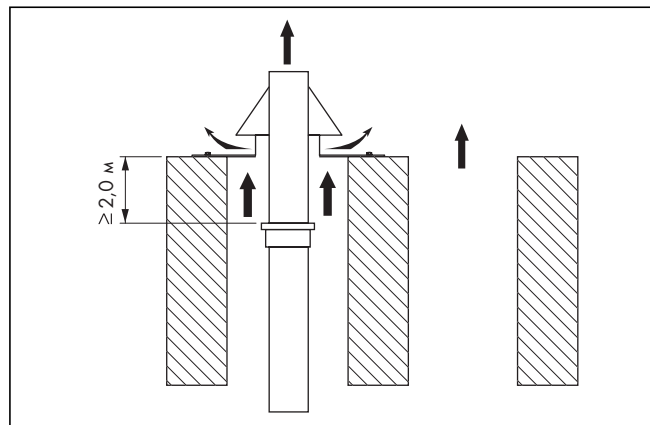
Высота дымовой трубы над выпускным газопроводом из ПП с устьем из нержавеющей стали - с забором воздуха из помещения
